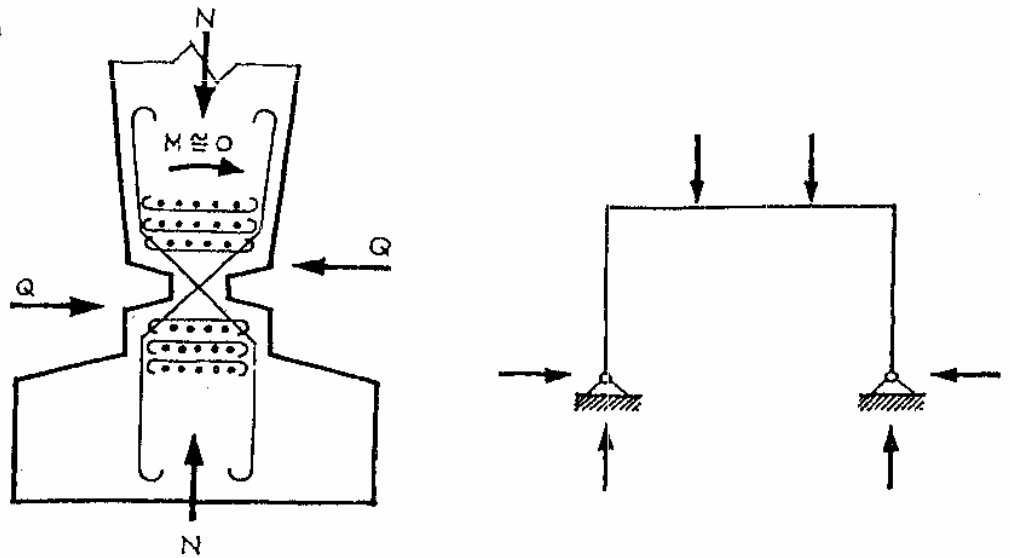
Detalle de articulación plástica en hormigón armado.
